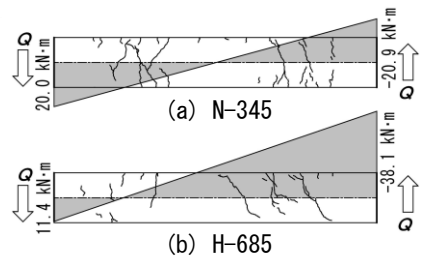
ひび割れ状況 ($R=0.02\text{rad.}$ 加力時)
